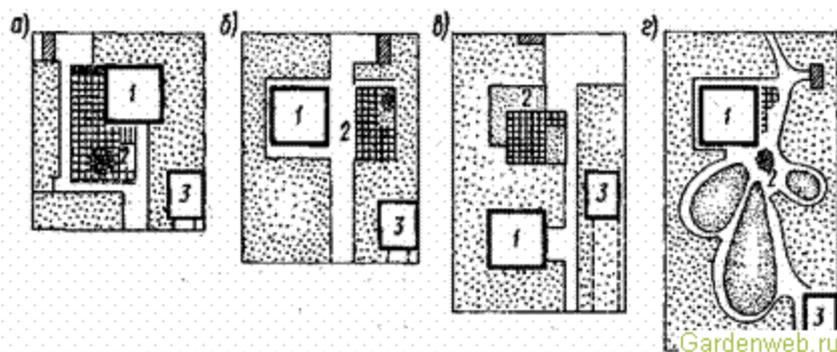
Схема расположения площадки для отдыха на участках различных размеров: о — терраса рядом с домом; б — внутренний дворик; в — отдельная площадка; г — система лужаек; 1 — жилой дом; 2 — площадка для отдыха; 3 — гараж
